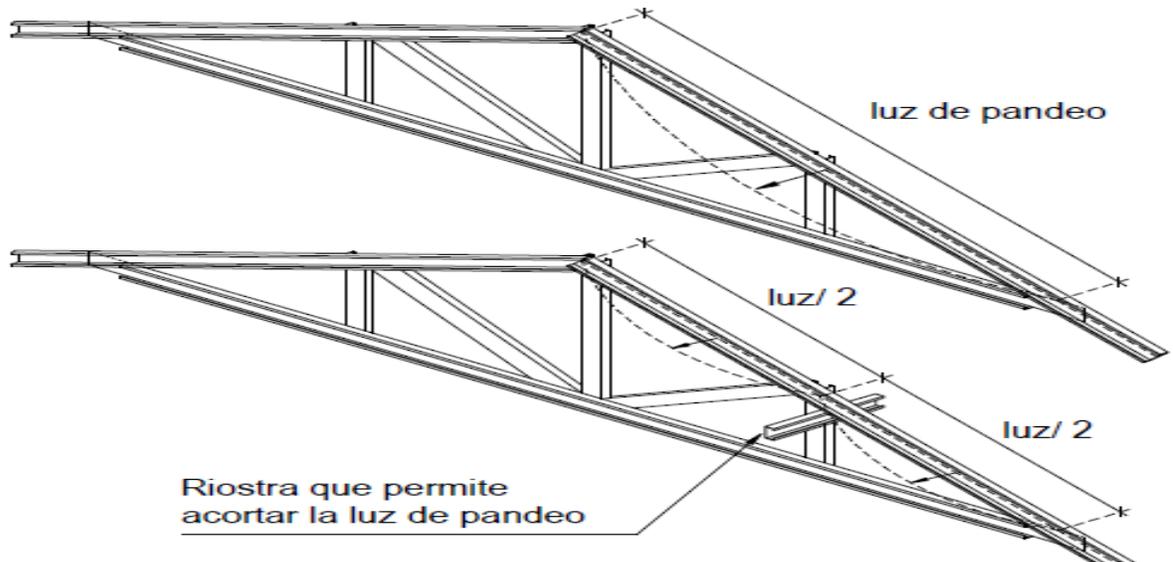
Detalle de la colocación de un arriostramiento en los nudos para la disminución de la luz de pandeo.
